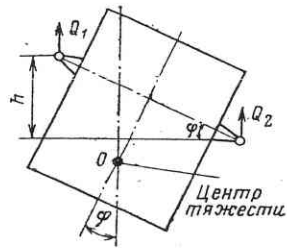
Расчетная схема подъема груза двумя кранами
